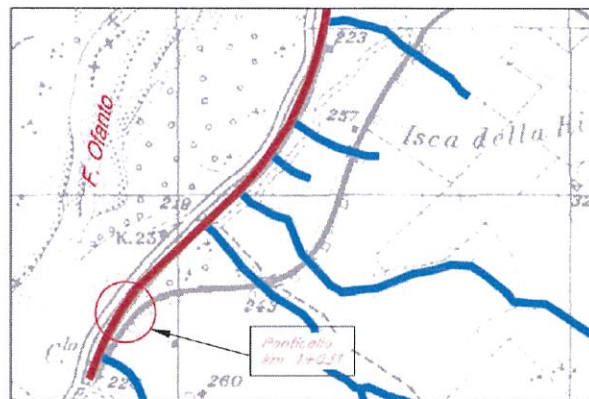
km 1+031: Inquadramento planimetrico dell'attraversamento
